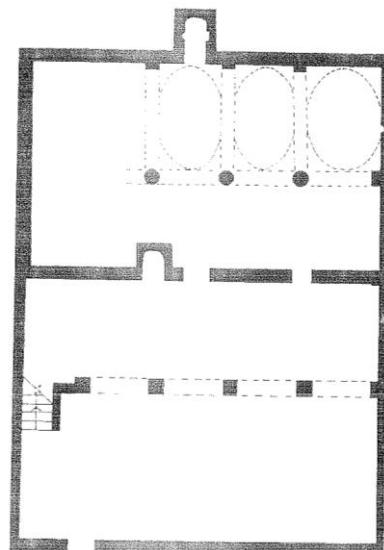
مسقّط أفقى لمسجد سلطان الخميسيانى
